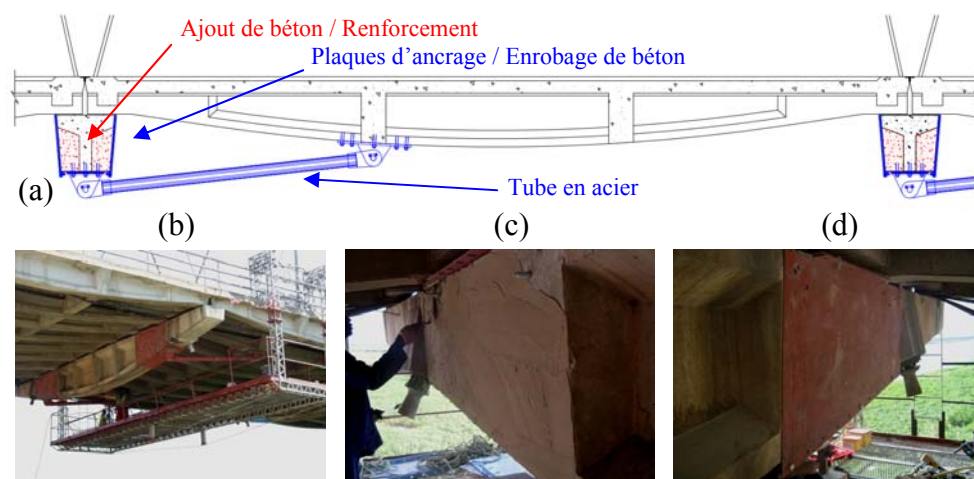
Stabilisation des poutres transversales: (a) Vue longitudinale, (b) vue générale, (c) installations de renforts en béton, (d) mise en place des éléments métalliques et des enrobages en béton.
